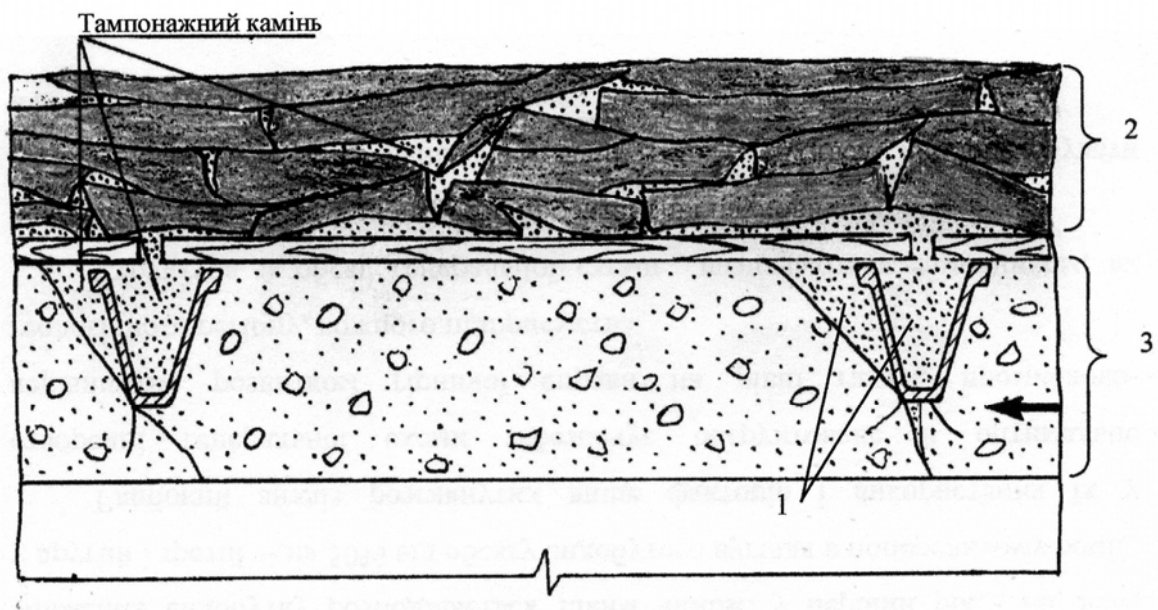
Схема перерізу виробки після закачування цементного розчину: 1 – заповнені твердіючим розчином корита йі пустоти за арками тимчасового кріплення; 2 – породобетонна оболонка; 3 – залізобетонне кріплення
